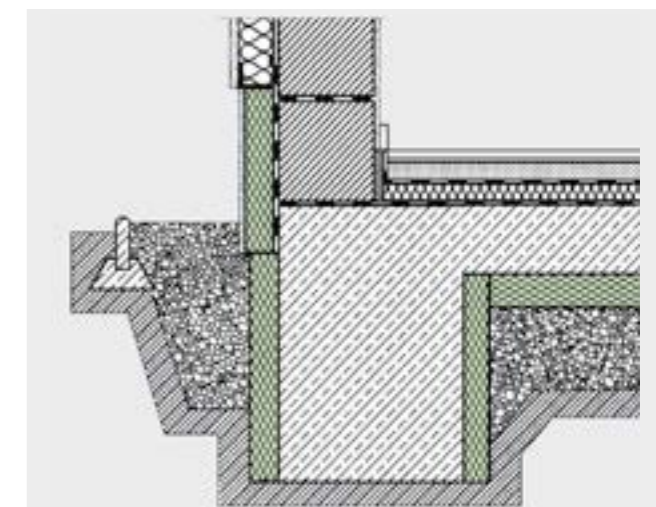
Isolamento delle fondamenta e raccordo al sistema isolante a cappotto esterno.
